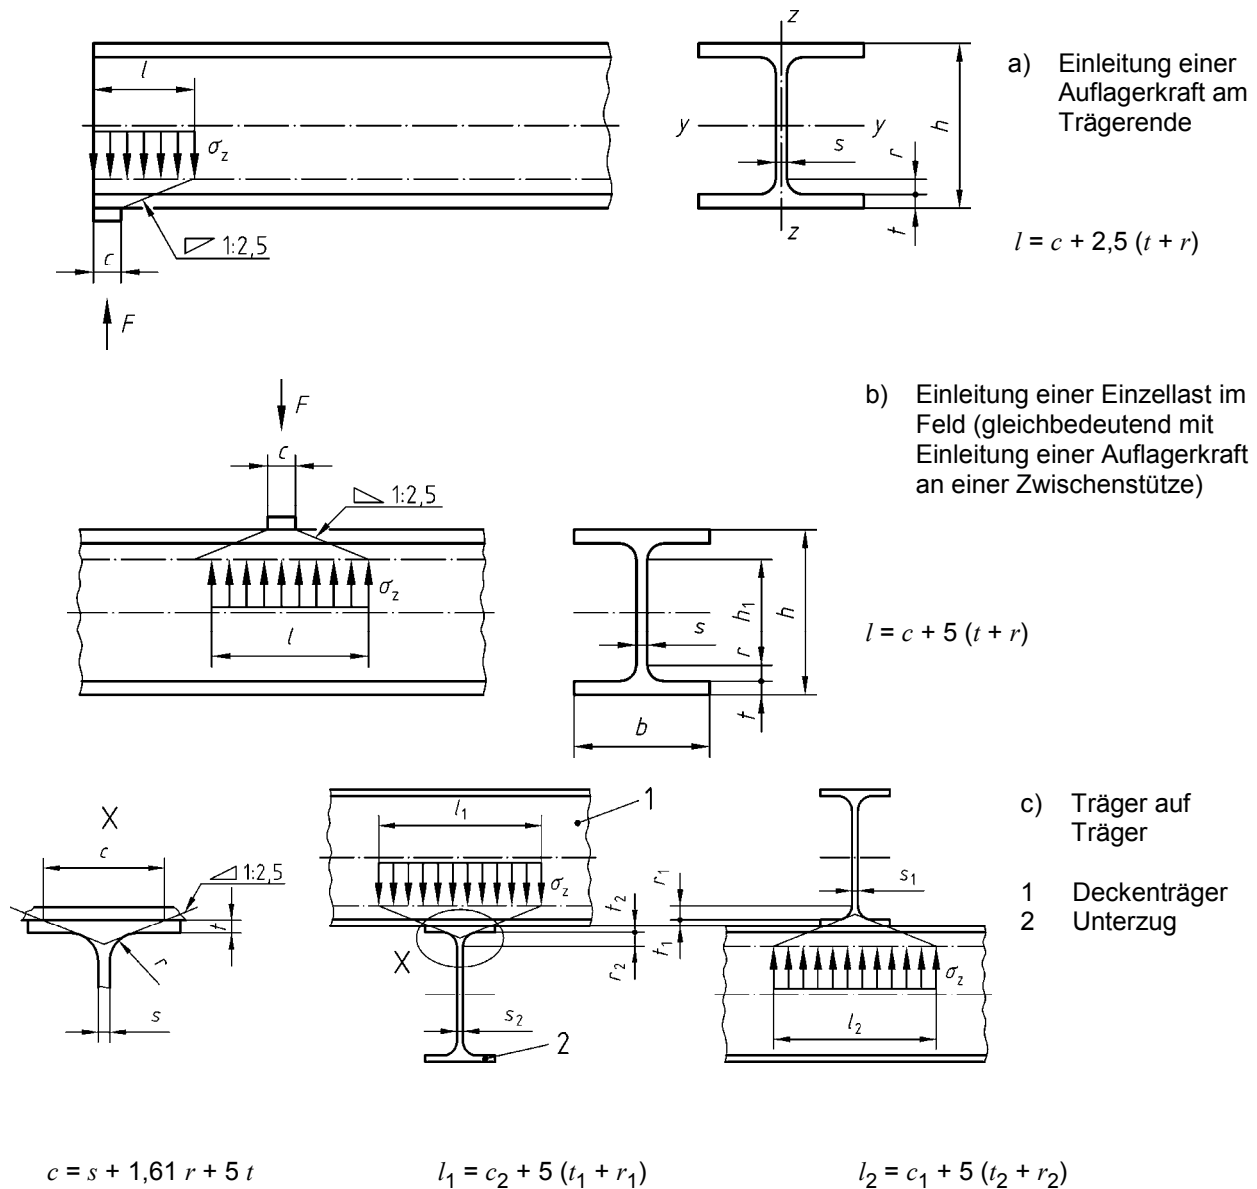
Rippenlose Lasteinleitung bei Walz- und geschweißten Profilen mit I-Querschnitt
